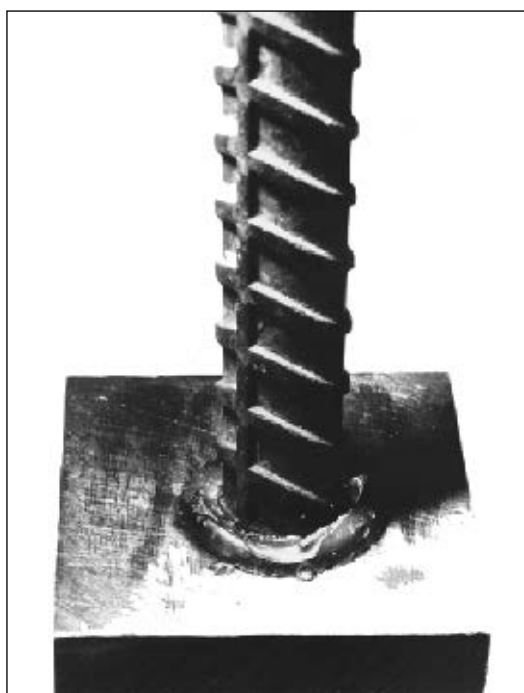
Сварное соединение стержня из стали А-II с пластиной из стали 09Г2С
